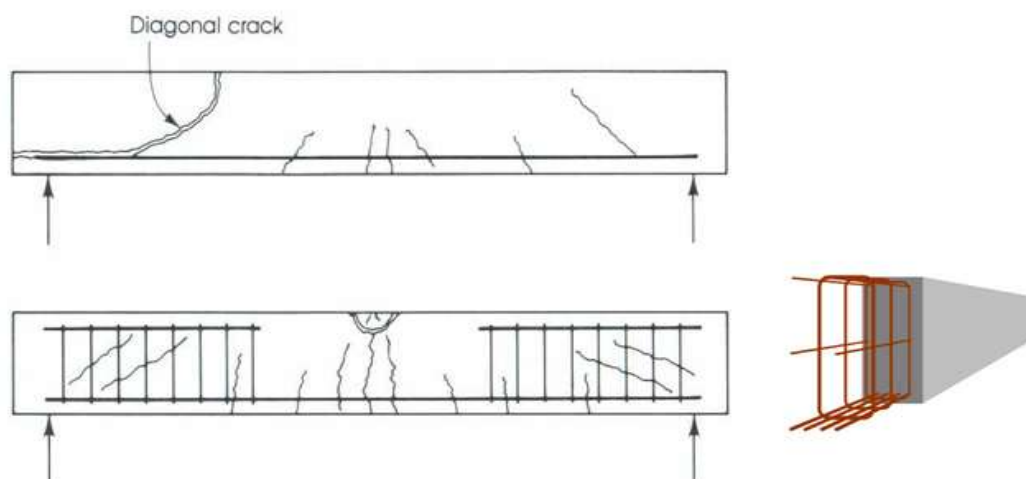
I.1: Deux poutres isostatiques dont la première ne comporte pas d'armatures transversale [7].
